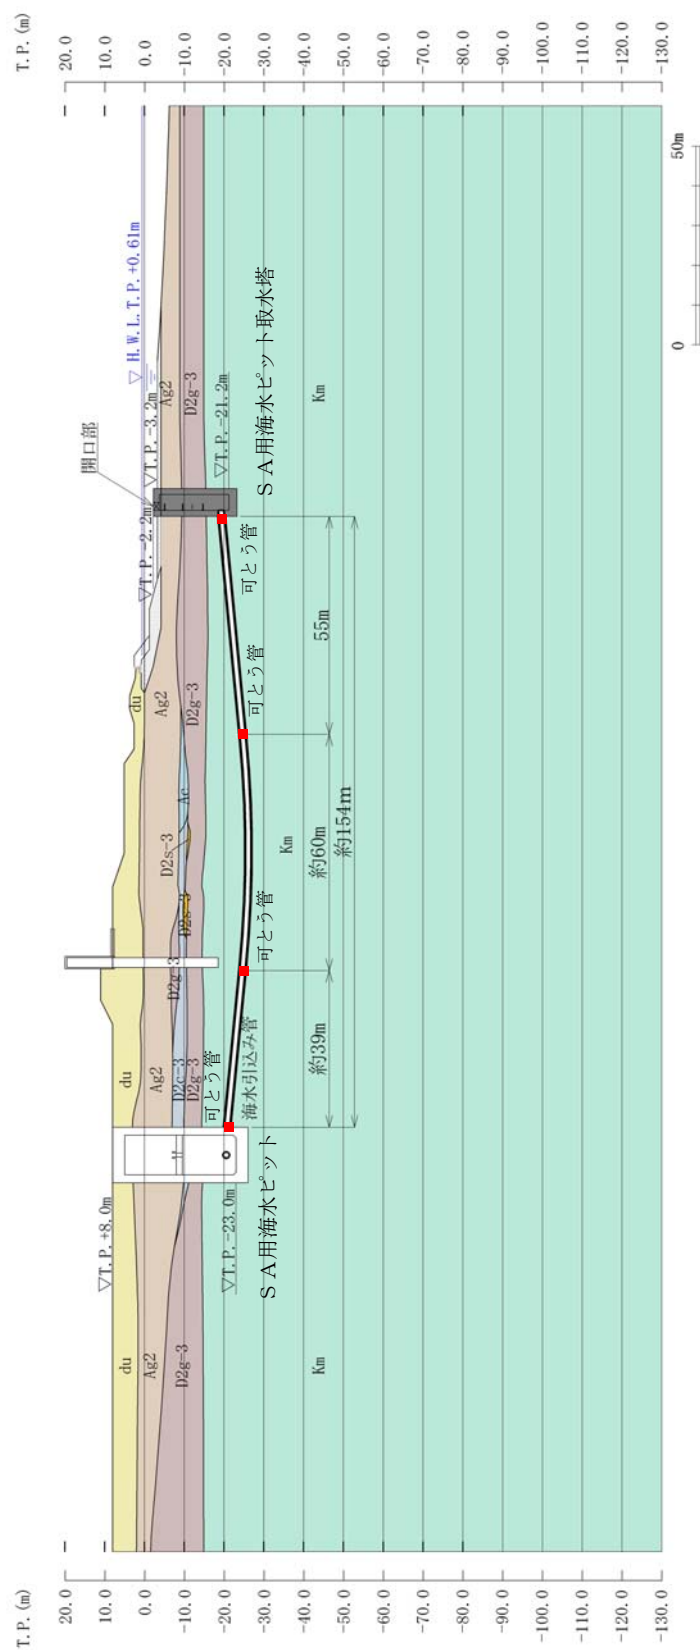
(1) S A用海水ピット取水塔 評価対象断面図 (①-①断面)
